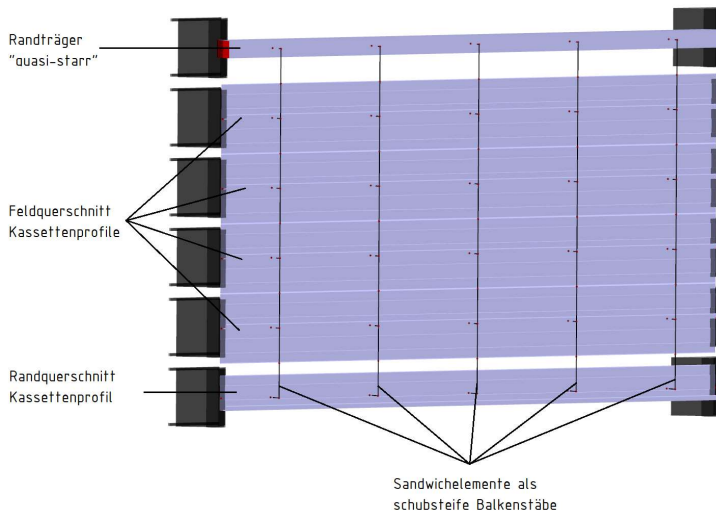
Stabwerksmodell Referenzgebäude A (Fassadenabschnitt 5000 x 3000 mm)
